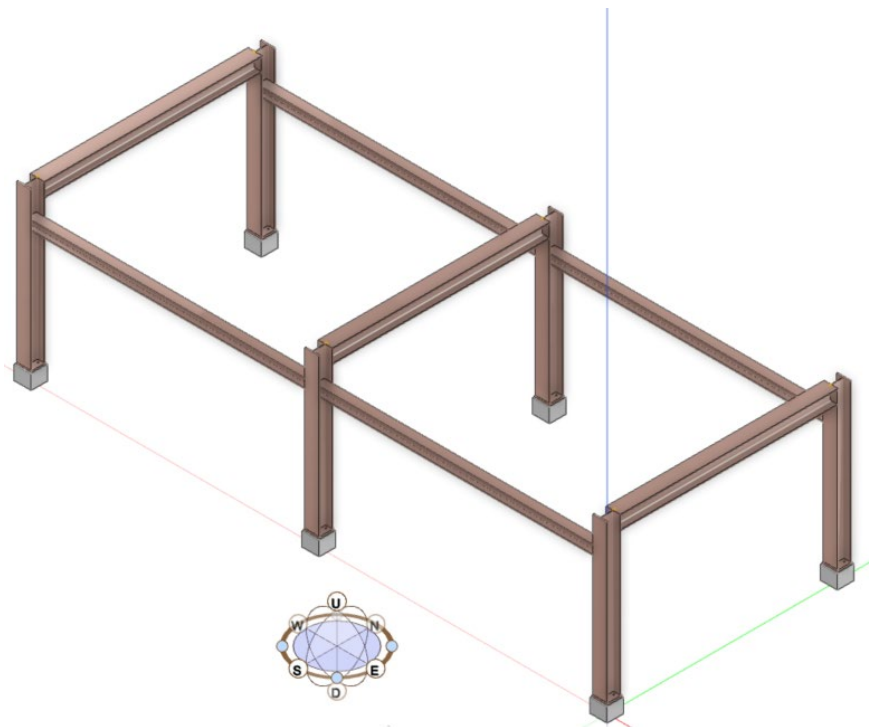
captura del rack, formado por 3 pórticos y 4 vigas transversales
